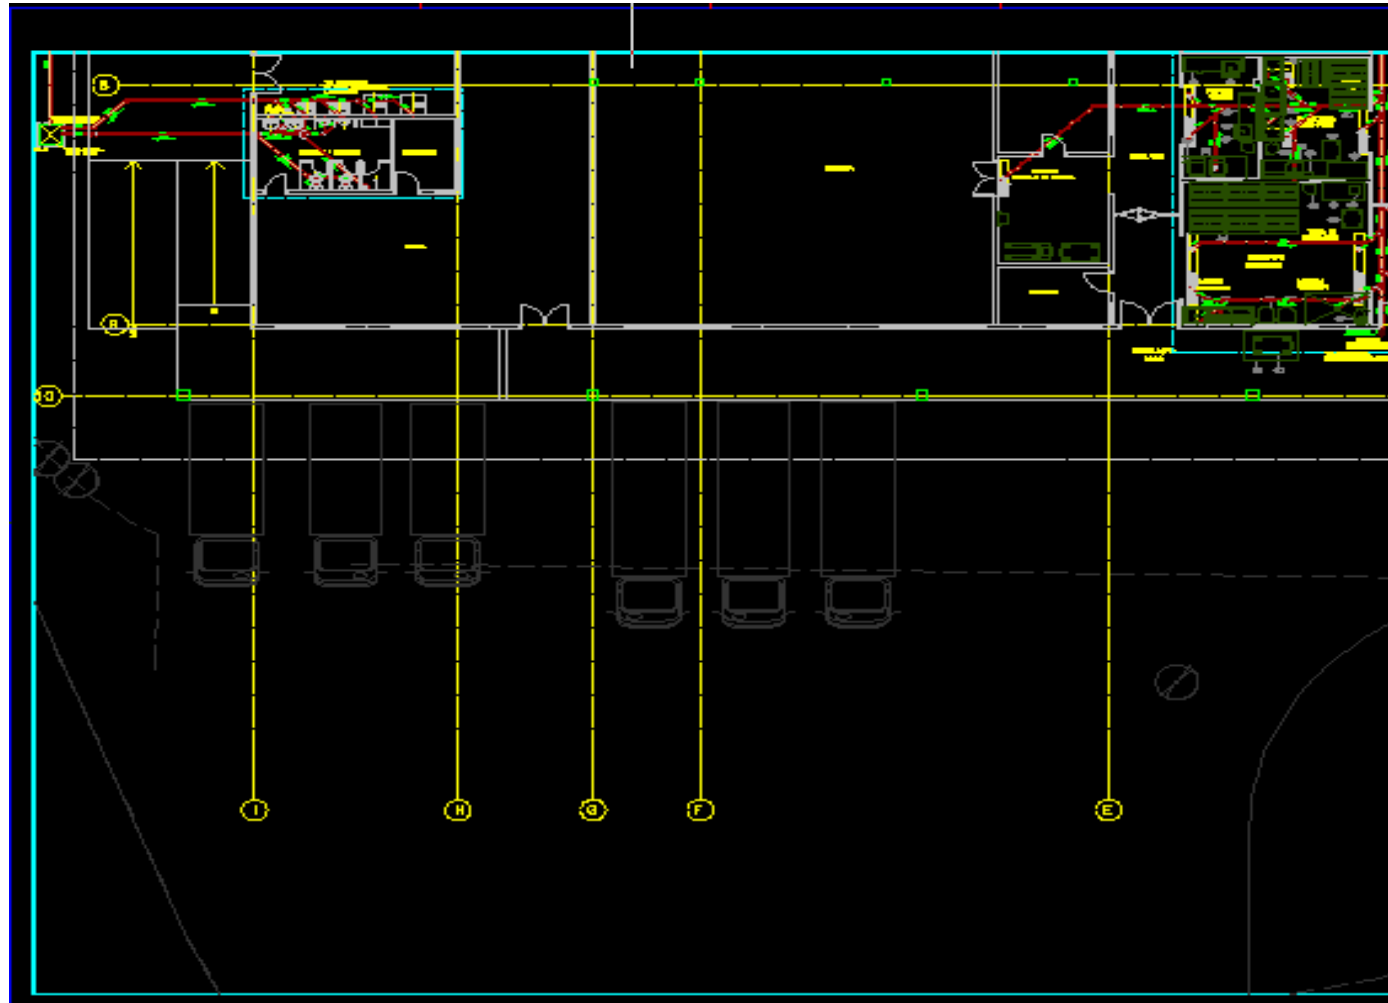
Projeto hidrossanitário – Planta 3 - Restaurante Central da VALE S.A.
